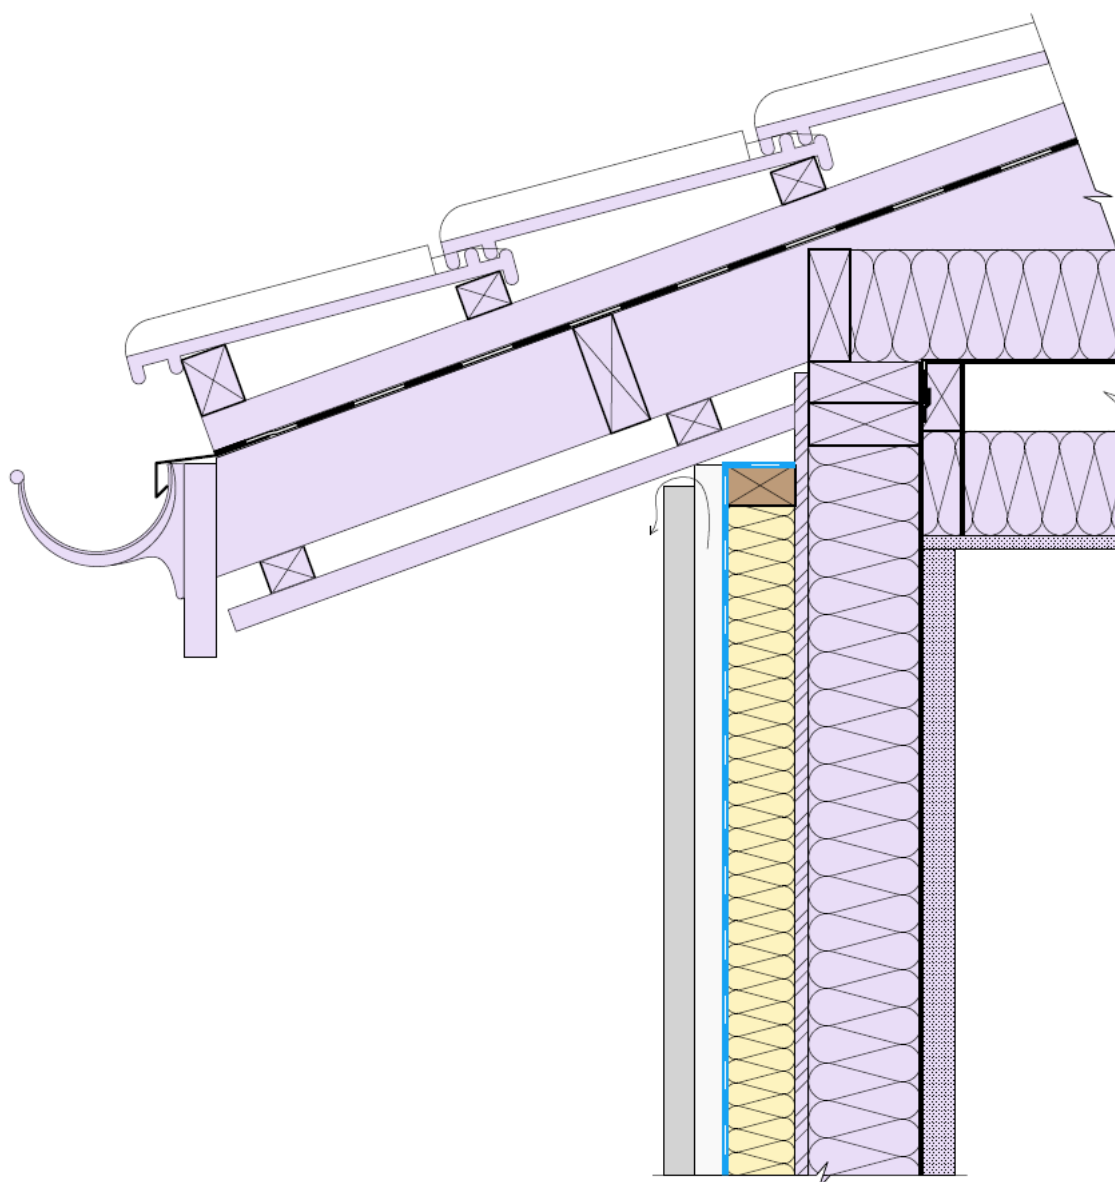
Raccordement sous débord de toiture (coupe verticale)
